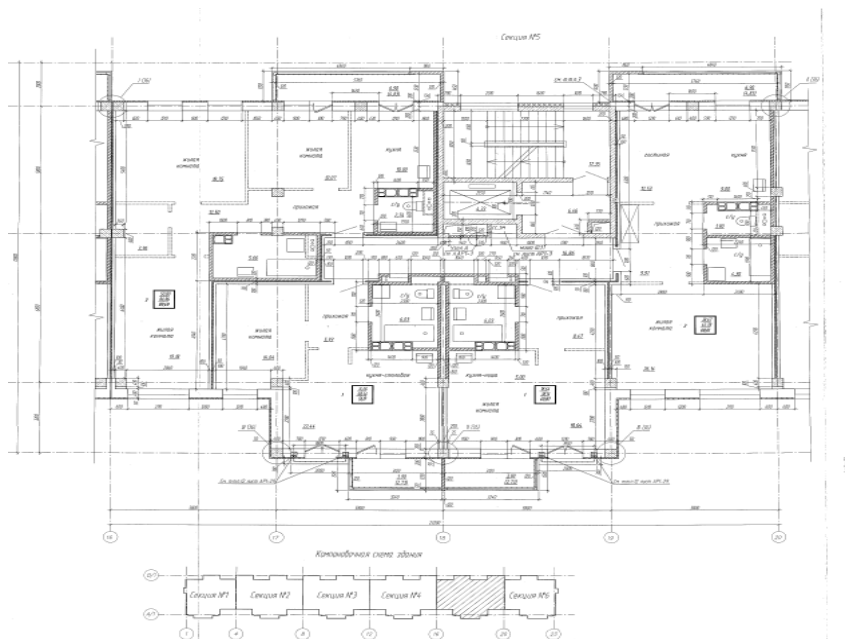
Горизонтальный разрез секции №5 жилого дома
